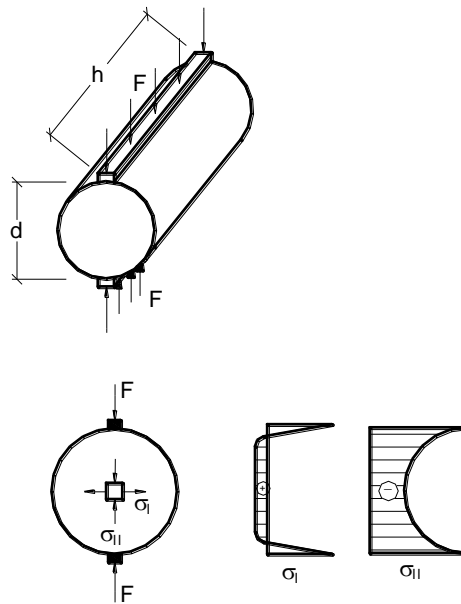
Resistência do concreto à tração determinada por ensaio de compressão diametral. (FONTE: SÜSSEKIND, 1985).
